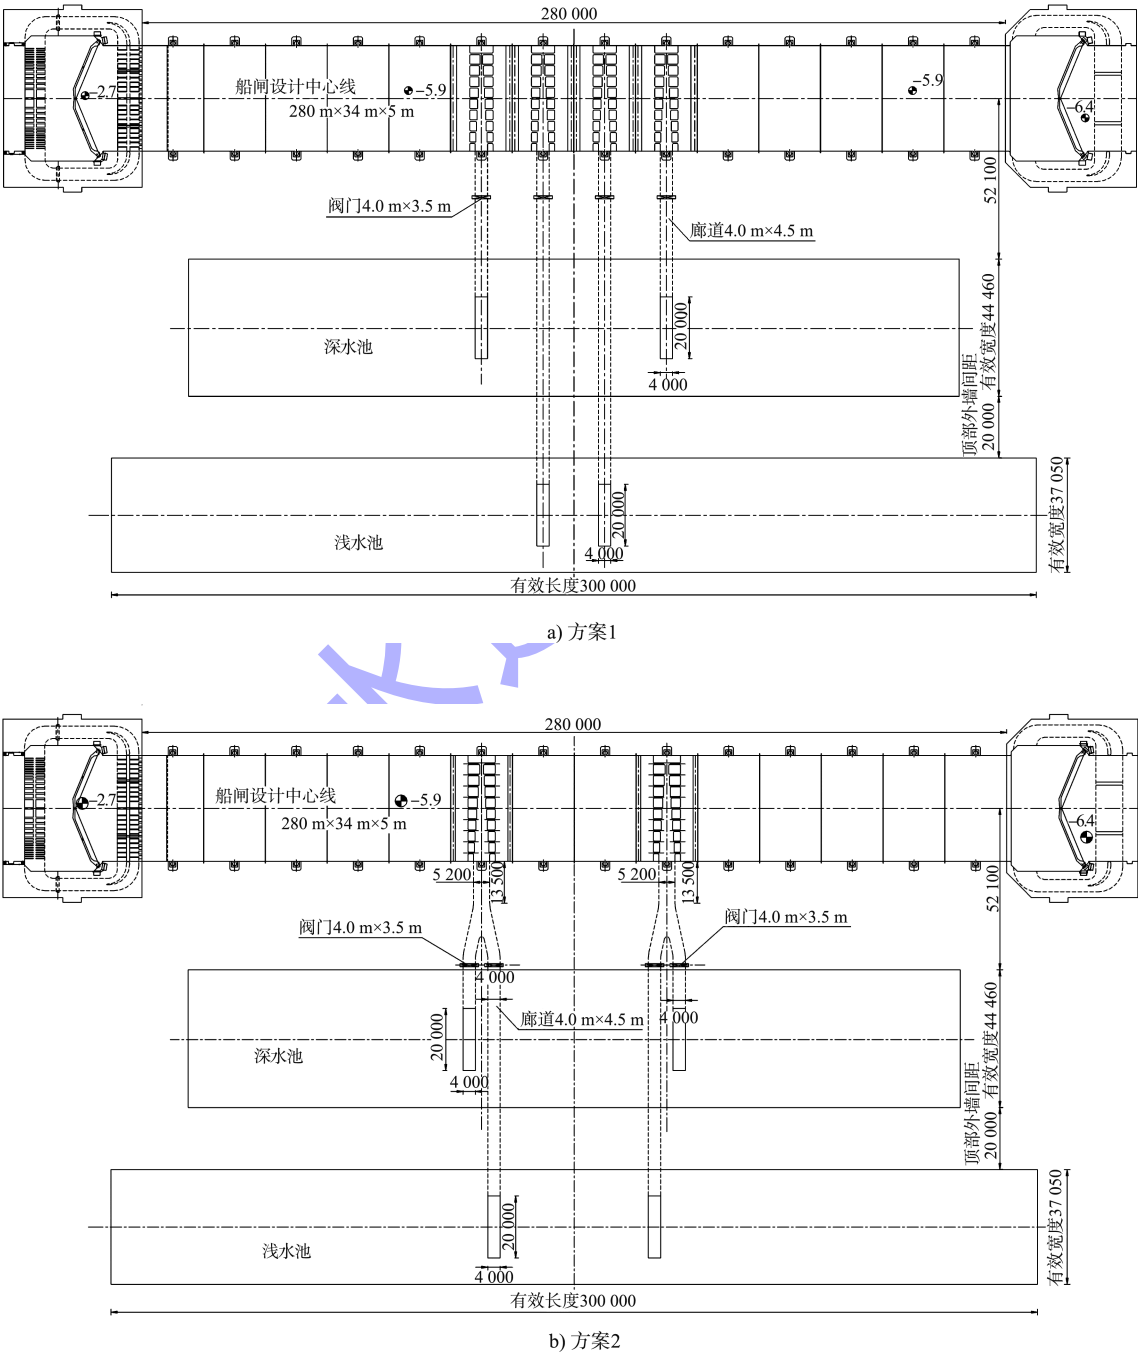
多级省水池输水系统平面布置 (高程: m; 尺寸: mm)
